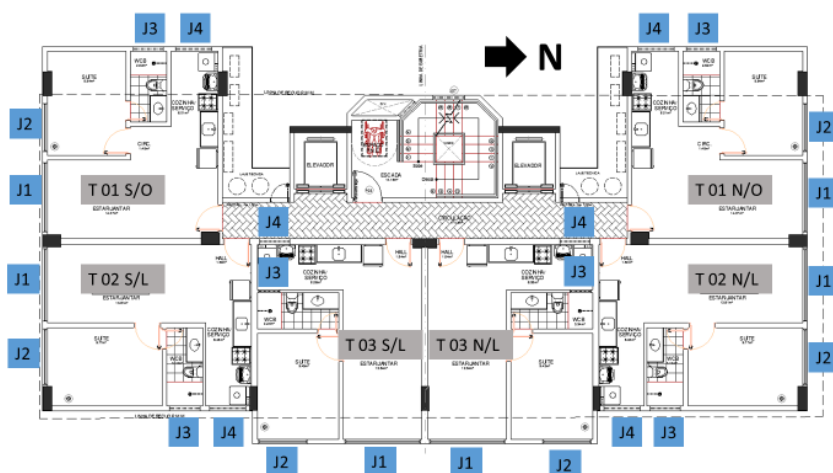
Planta baixa do pavimento tipo do Edifício.
